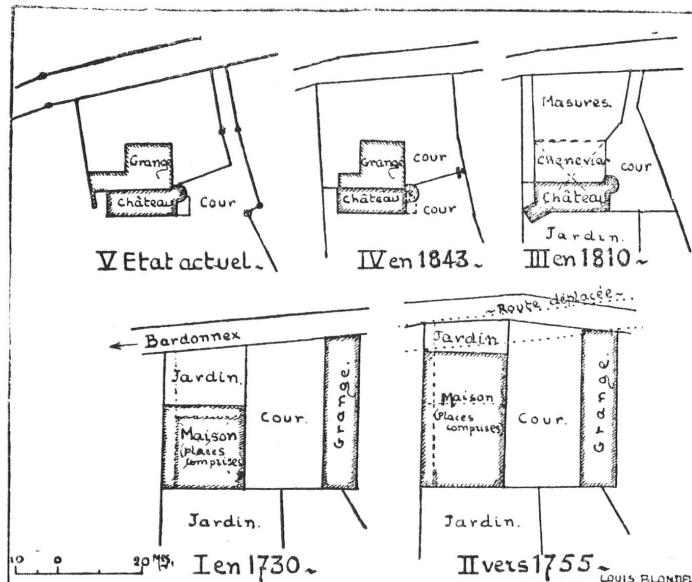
Plans successifs de la maison forte de Bardonnex.
